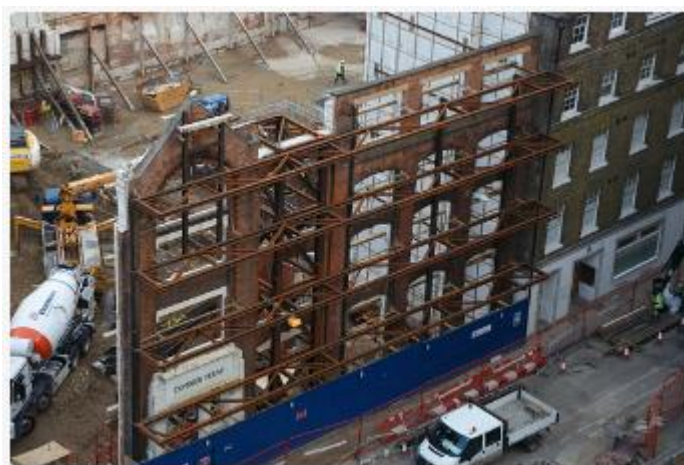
Vanjski konstrukcija za pridržavanje fasade [2]
